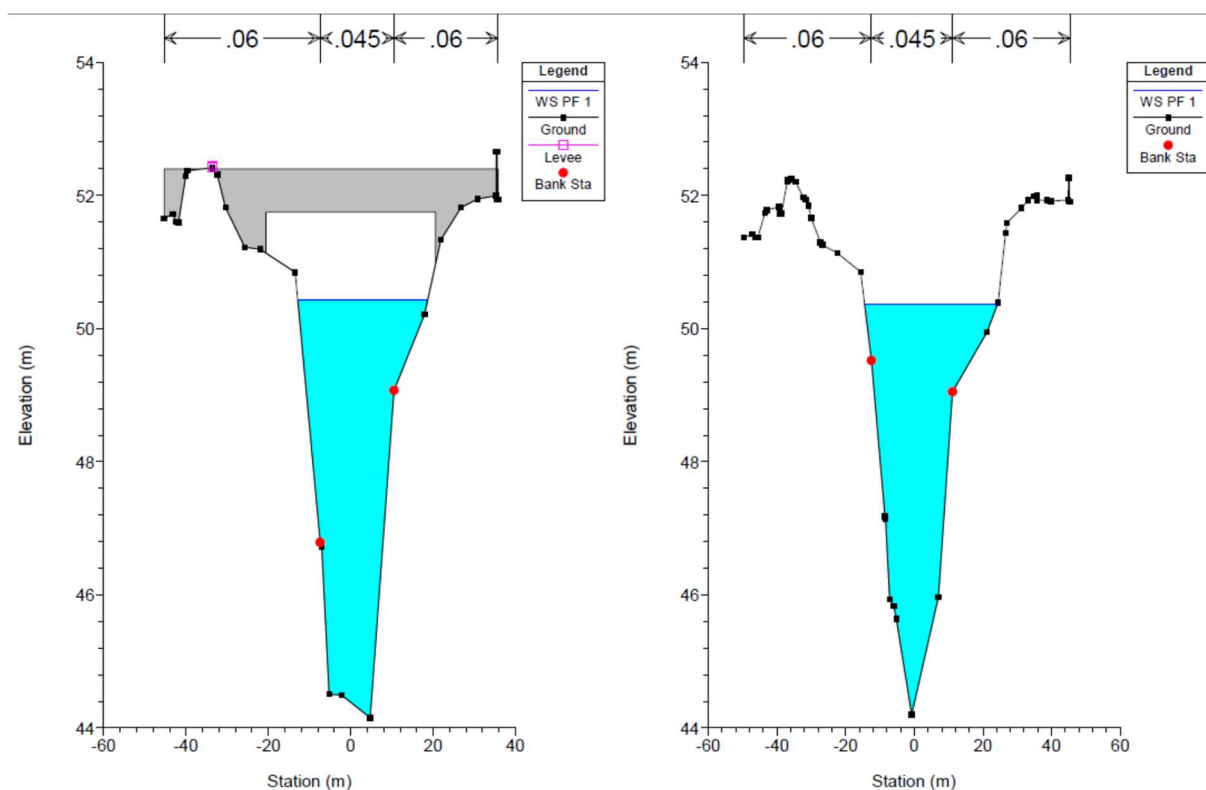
Sezione 6.4 monte (a sinistra) e sezione 6.3 (a destra), stato di progetto
